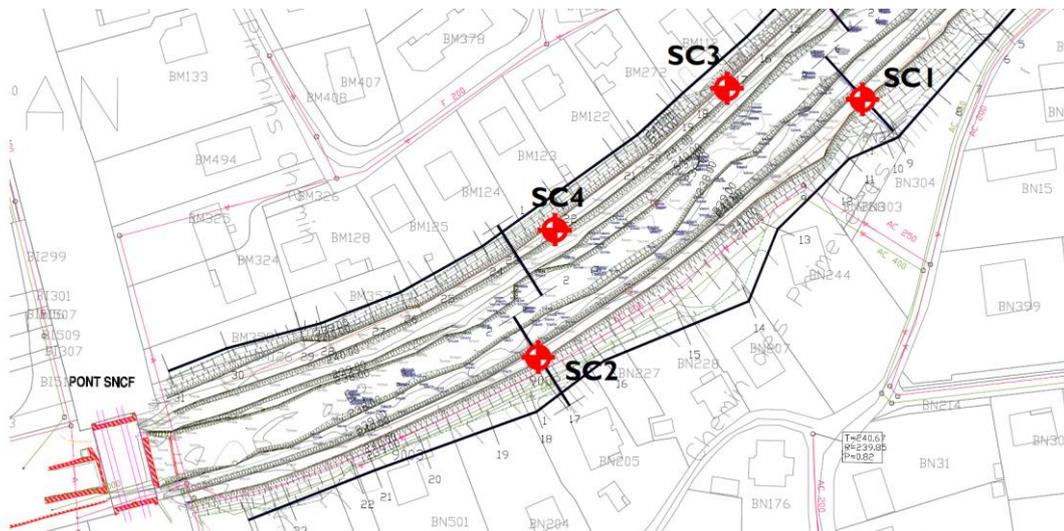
Plan d'implantation des sondages de la G2 PRO réalisée par Fondasol en 2017
